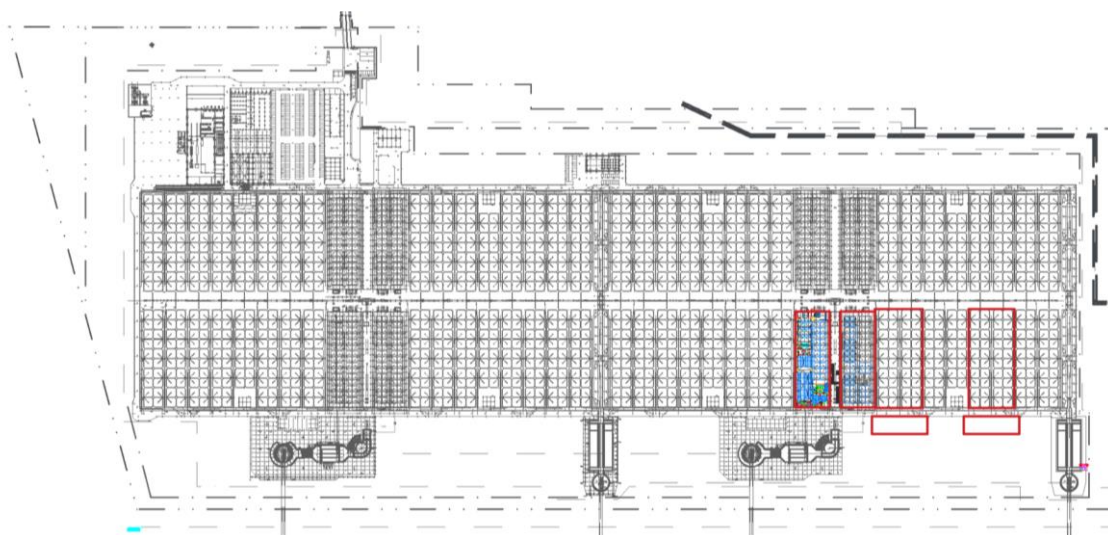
Planta Geral do projeto de maternidade de peixes planos e engorda de linguado da FLATLANTIC: Zona de intervenção, maternidade e engorda, delimitada a vermelho
